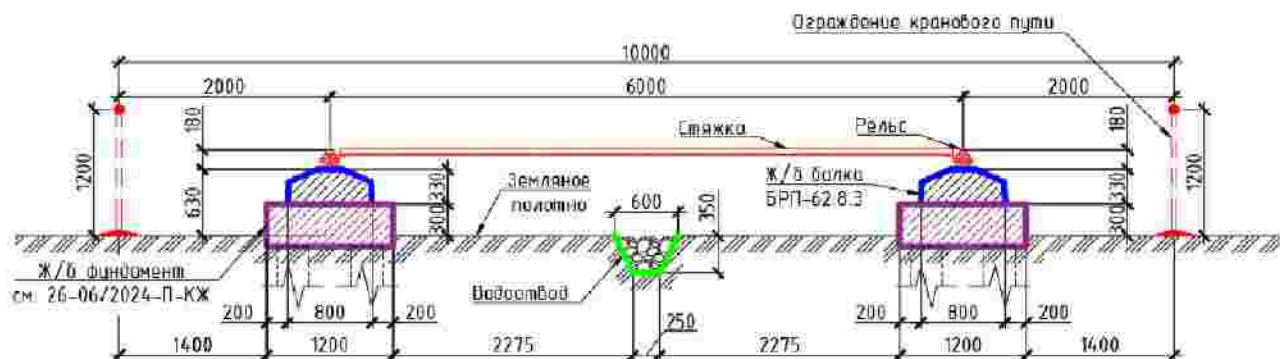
Устройство кранового пути на железобетонном фундаменте
